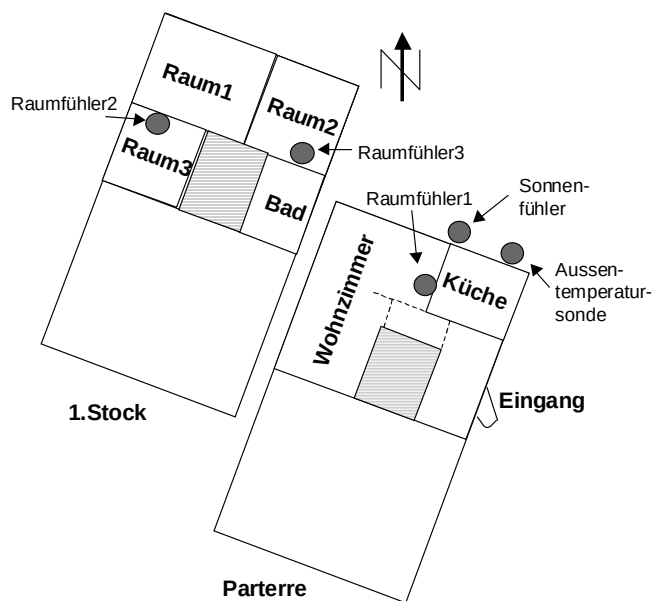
zeigt den Grundriss des Testgebäudes in Basel mit der Positionierung der Messsonden, welche in Tabelle 26 detailliert sind.
